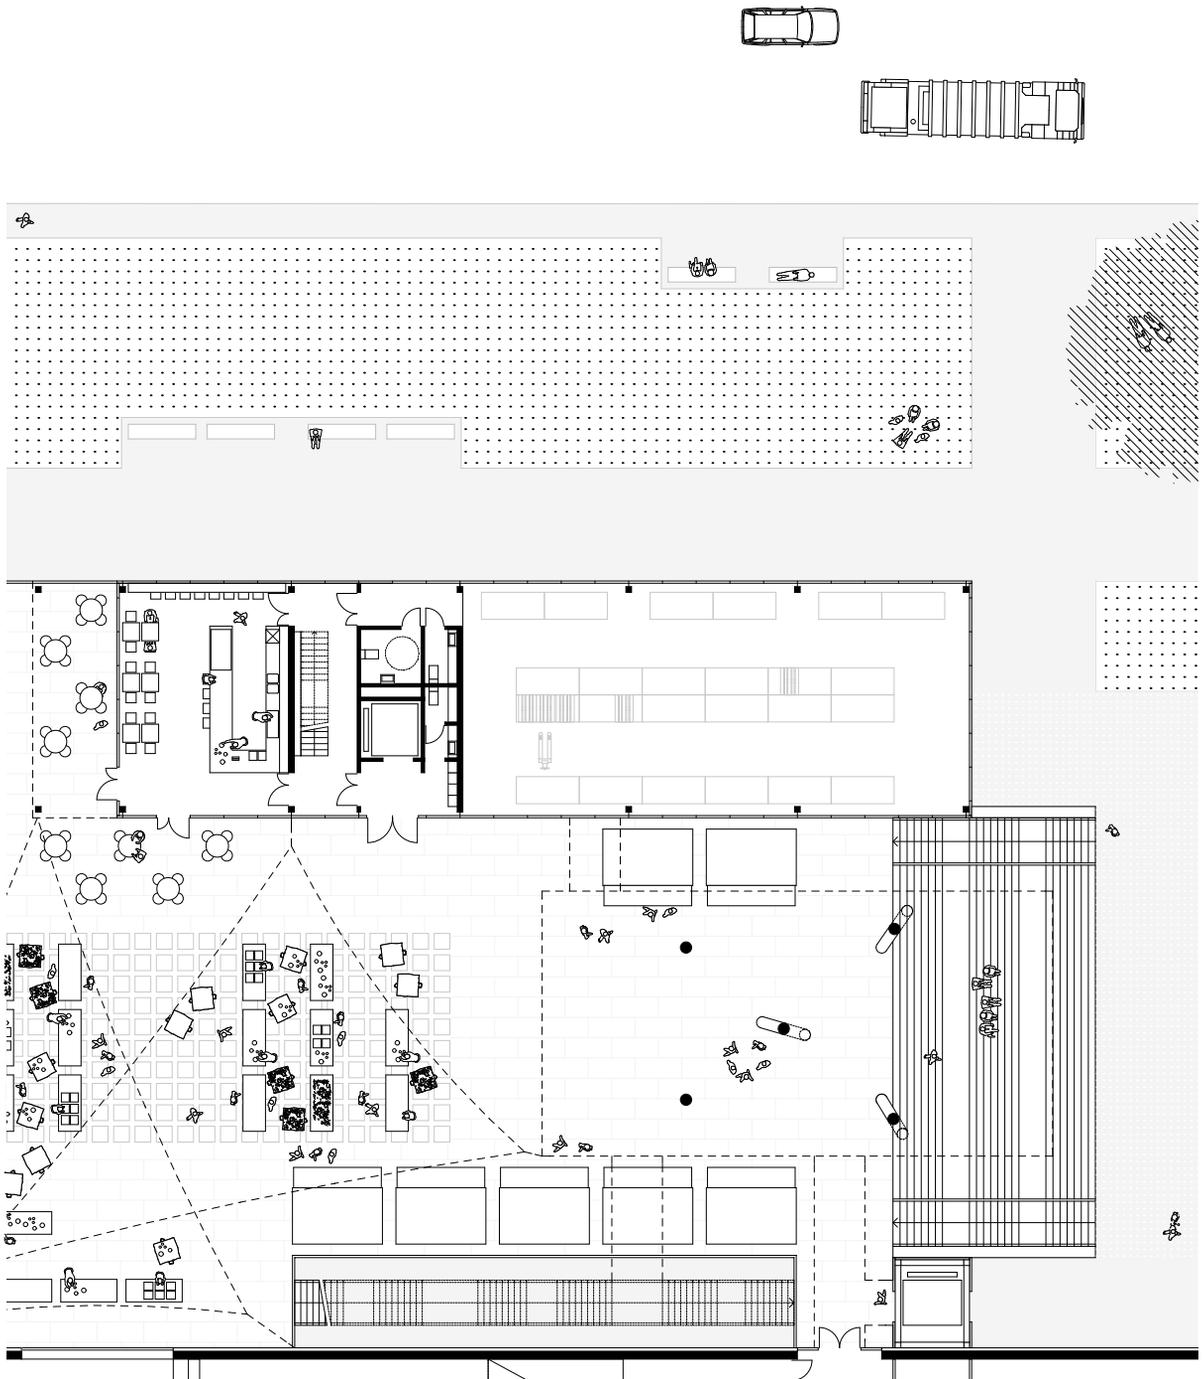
Grundrissausschnitt Marktplatz
